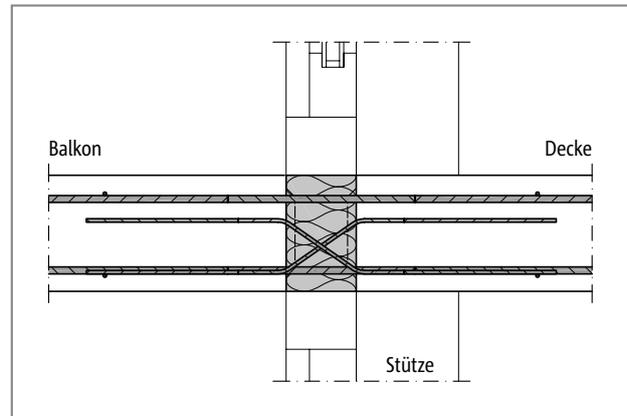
Schöck Isokorb® Typ DXT: Einbauschnitt; Flachdecke
